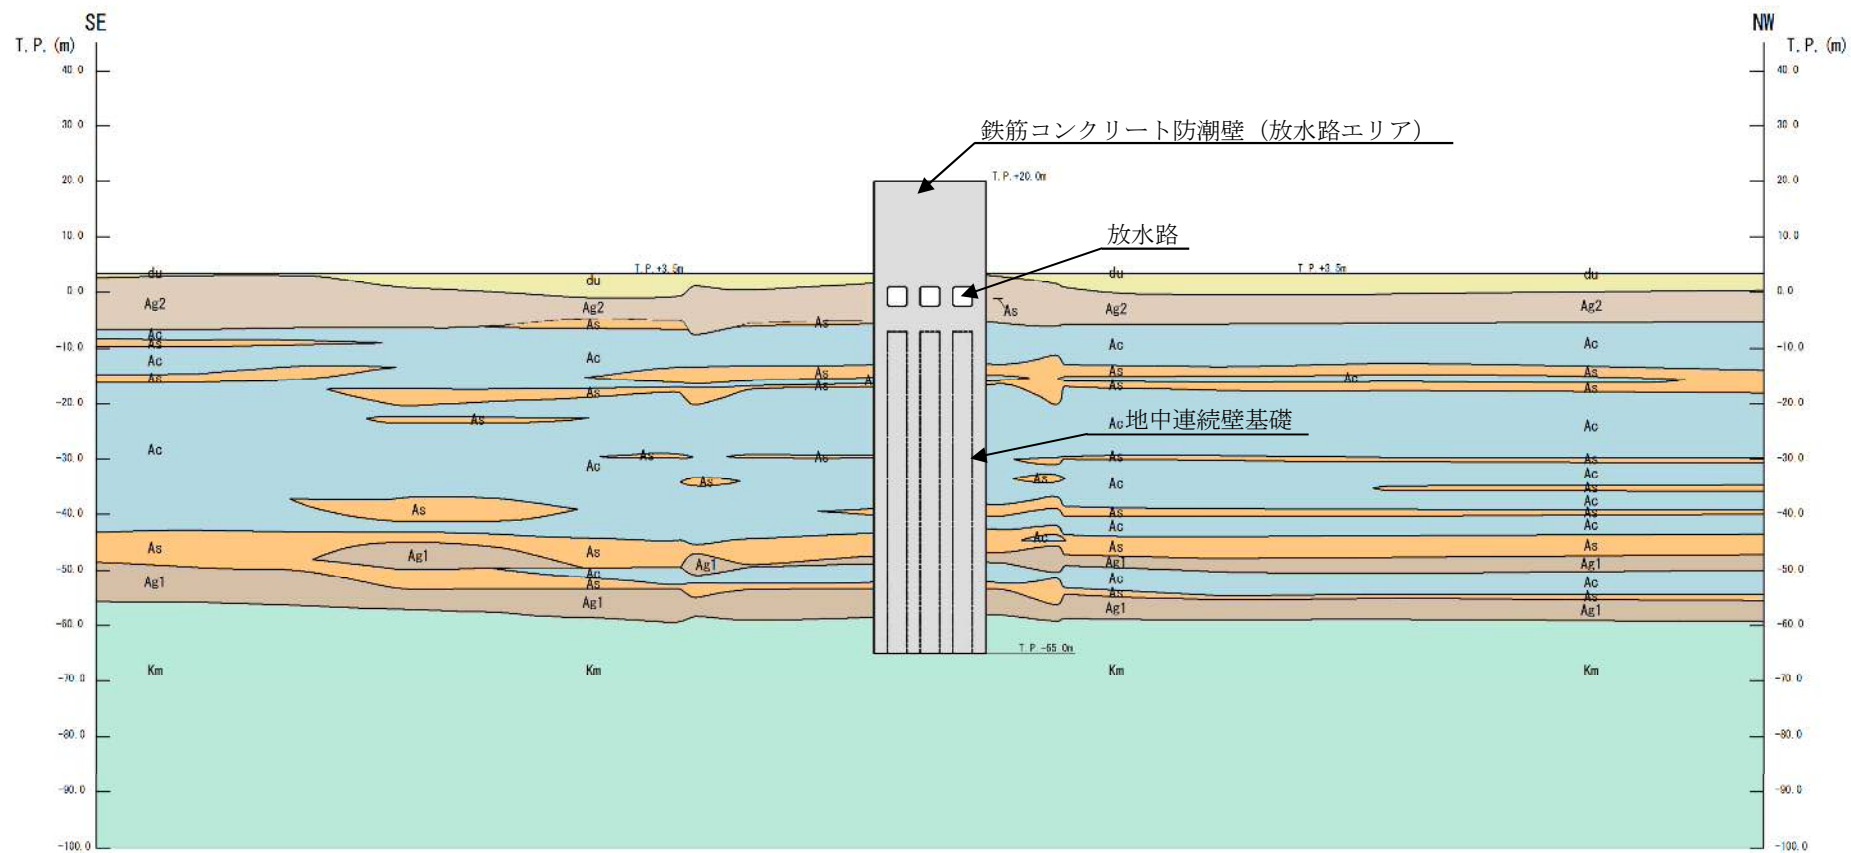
鉄筋コンクリート防潮壁（放水路エリア）の断面図（防潮壁縦断方向：②-②断面，防潮壁部）
